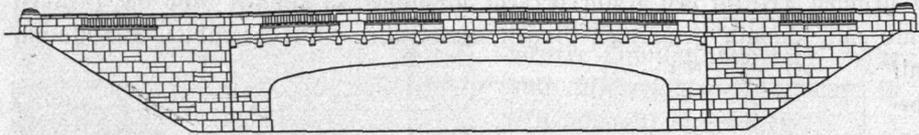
und 310. Barmbecker Straßenbrücke, Ansicht und Brüstungsgrundriß.
